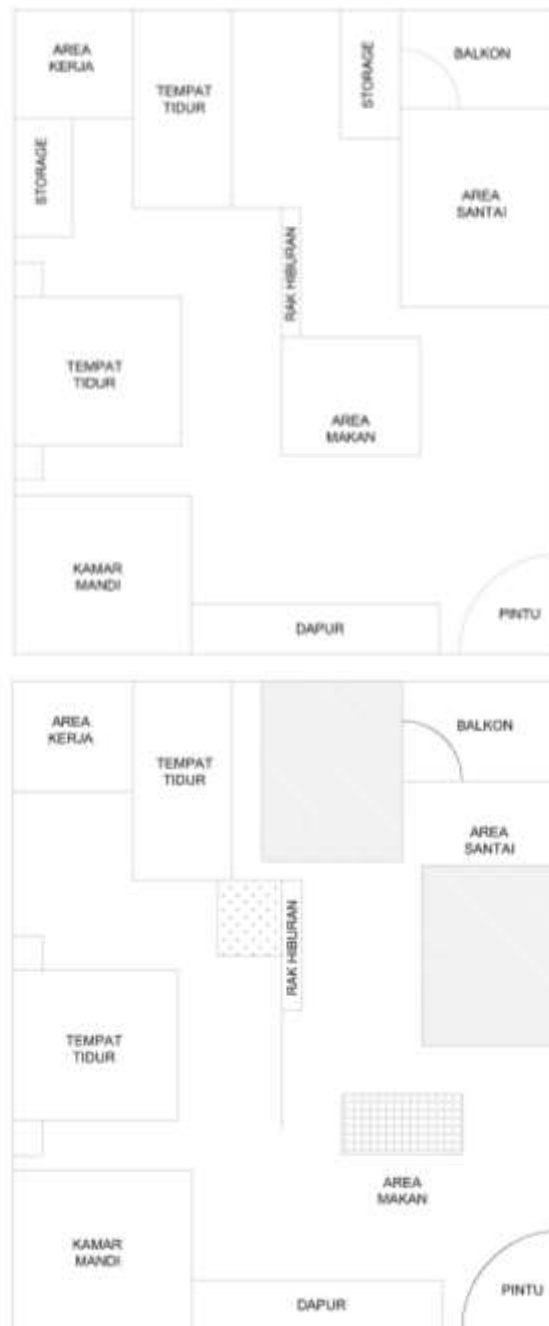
8 Penerapan furnitur set di apartemen tipe studio
